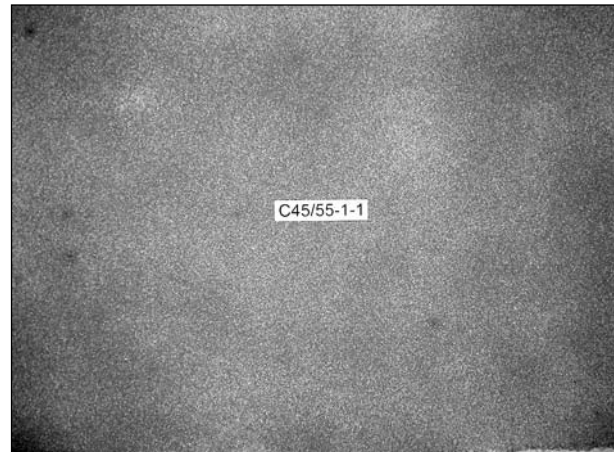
Grundierung 1 mit Abstreung auf Beton C35/45 („C45/55“) mit kleiner Rautiefe
